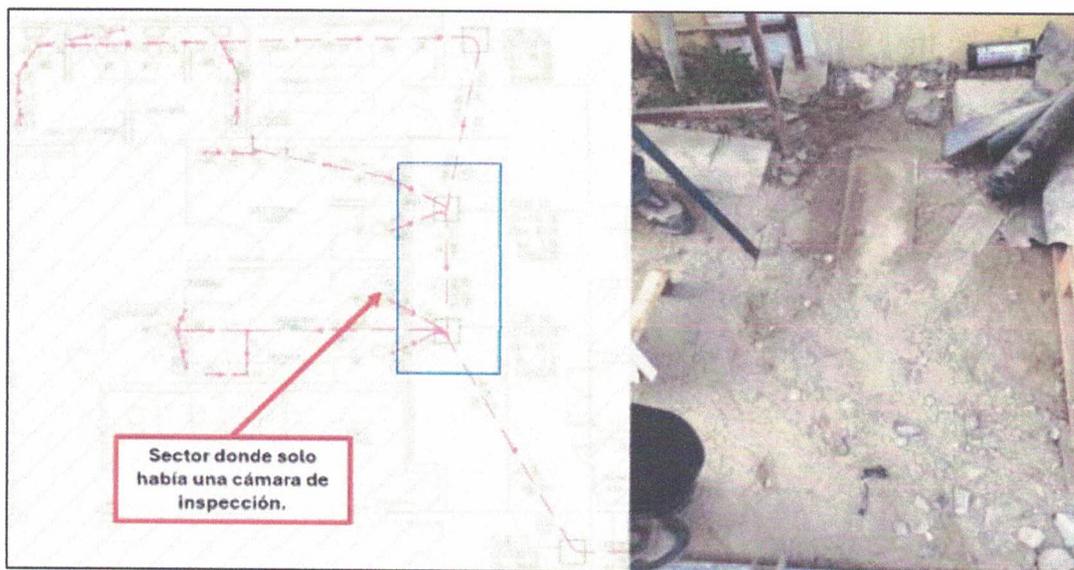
Fragmento de planimetría sanitaria donde se indica la existencia de dos cámaras de inspección en el sector y cámara localizada.
